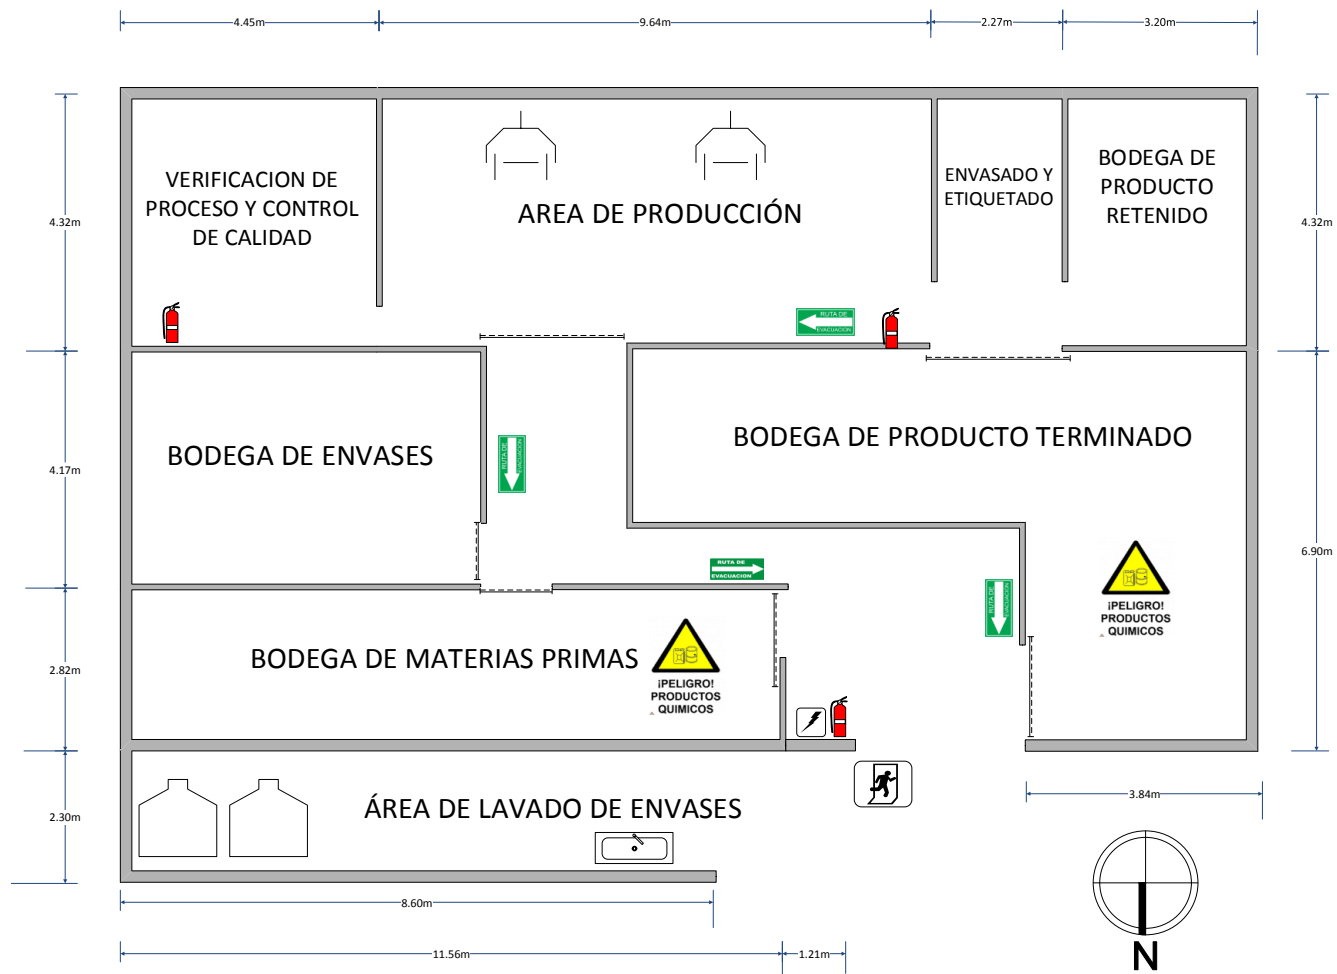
Plano arquitectónico de distribución de ambientes. Fuente: Elaboración propia.
